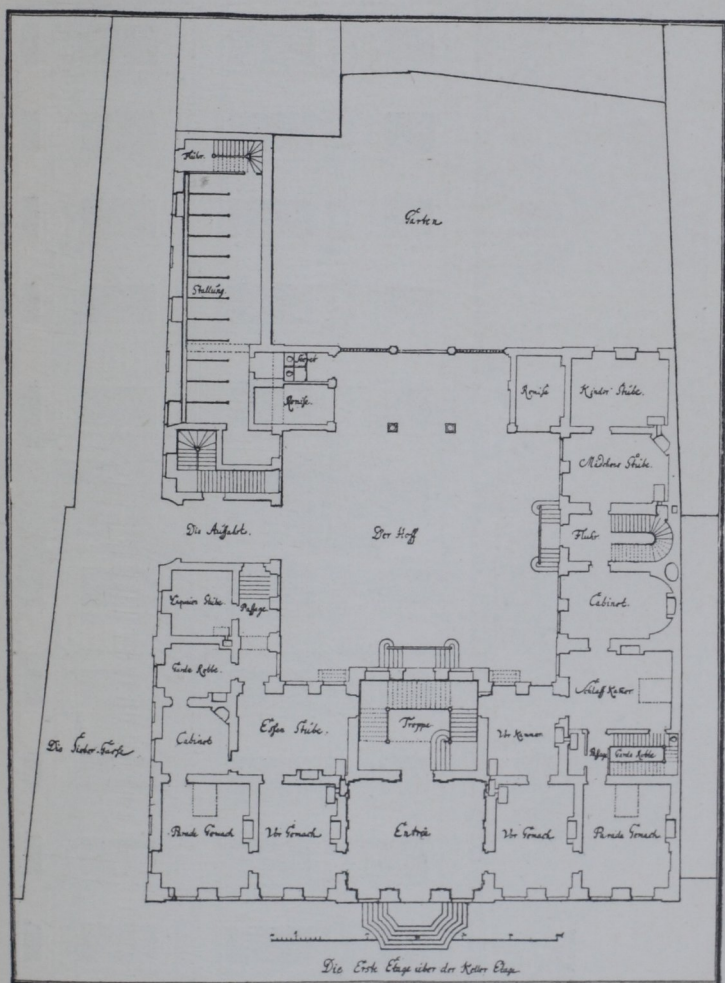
Kreuz'sches Palais zu Berlin. Nach einem alten Plan. 168)
